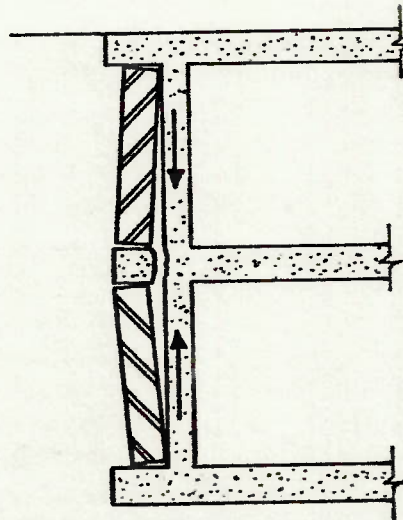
Fissura de tração desenvolvida na extremidade de uma viga, pelo arqueamento da alvenaria
